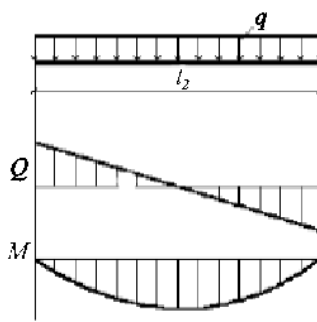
Расчетная схема балки настила (однопролетная разрезная балка)
